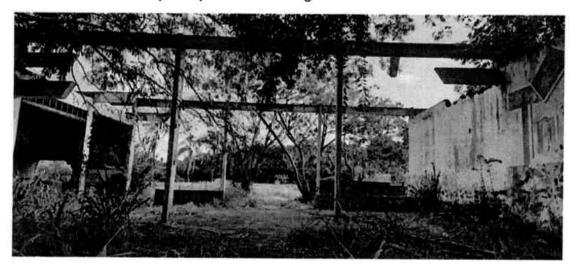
toda a cobertura, portas e janelas foram arrancadas.
